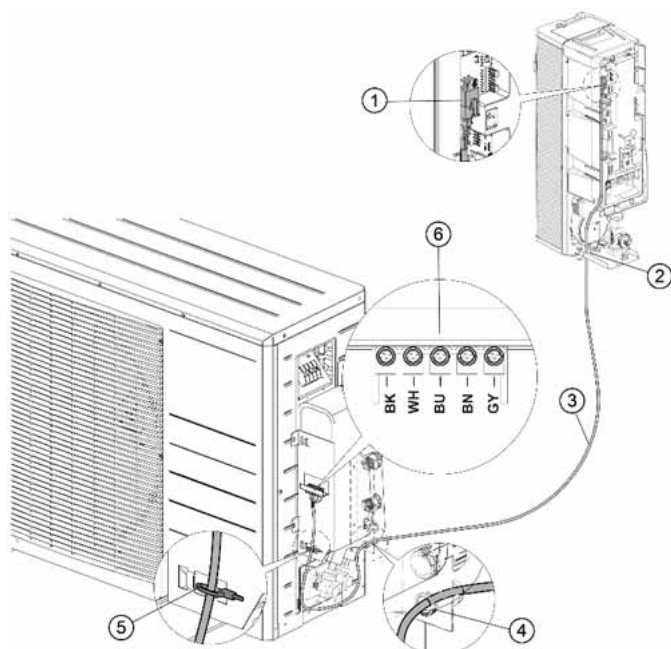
Befestigung der Drähte an der Fühlerklemmleiste ⑥
